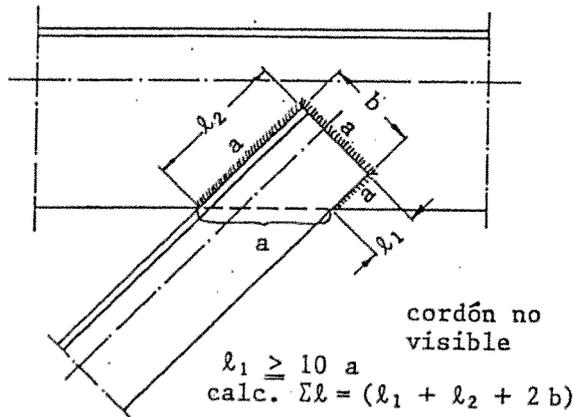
Empalme con soldaduras de filete en todo el perímetro
